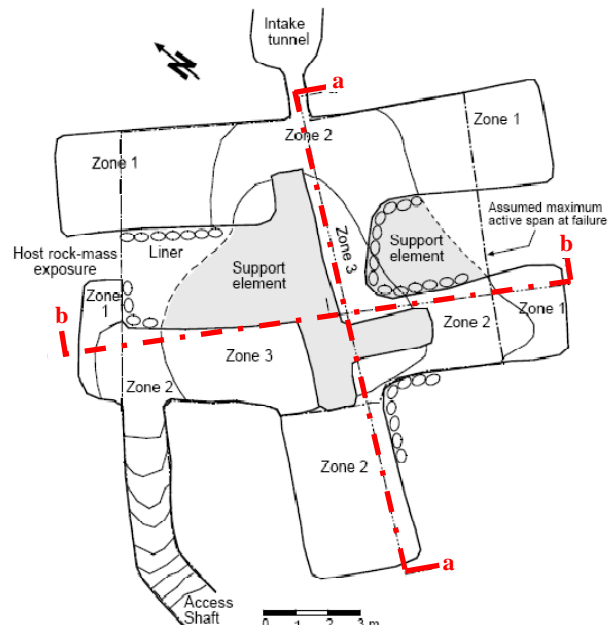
Vista in pianta della caverna (Hatzor & Benary, 1998)
